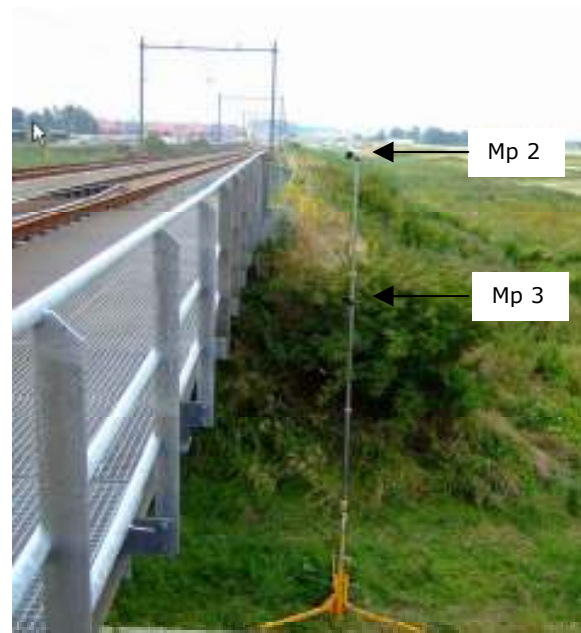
en 3: Situering meetpunten ter hoogte van aarden baan (km 8.0) en ter hoogte van brug (km 8.1)
